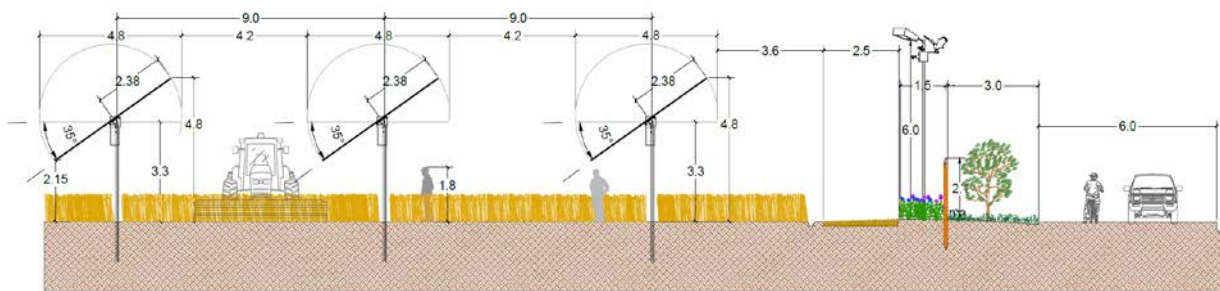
Particolare sezione delle strutture tracker con piantagioni di frumento nell'interfila dei moduli, strada perimetrale interna all'area di impianto con linee di impollinazione, recinzione ed ulivi mitiganti
